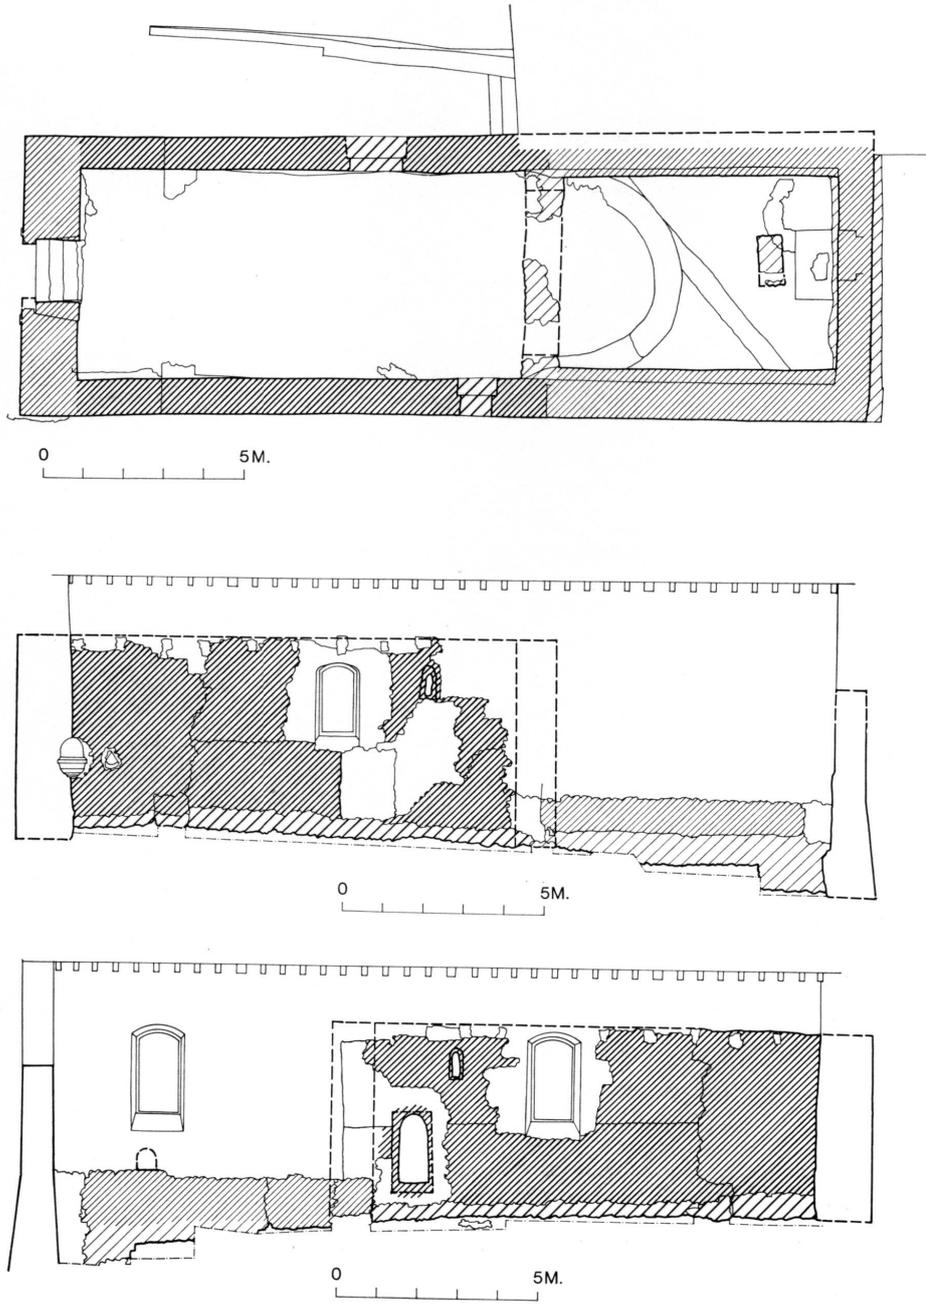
Deuxième église. Schémas du plan et des élévations intérieures nord et sud (pour la légende voir p. 19).
